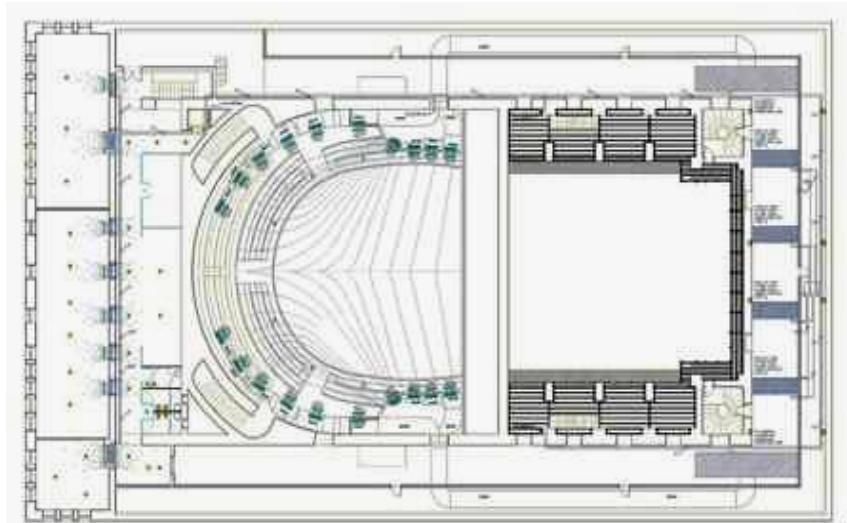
Planta del Teatro Romea de Murcia (SÁNCHEZ MERINA, J.).
